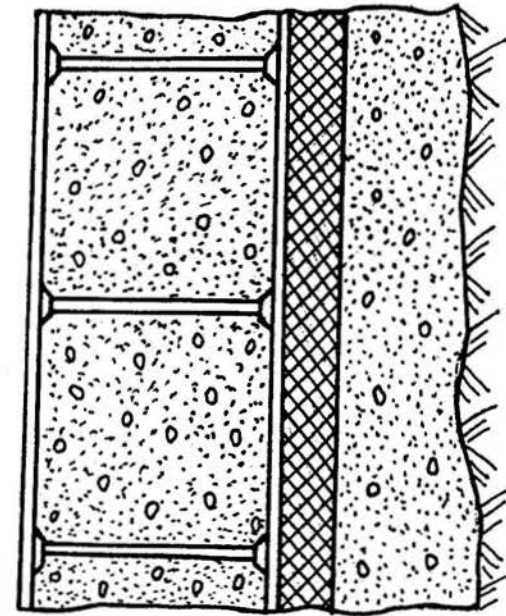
Fortificación con cilindro metálico, aislamiento con betumen y relleno de hormigón.
